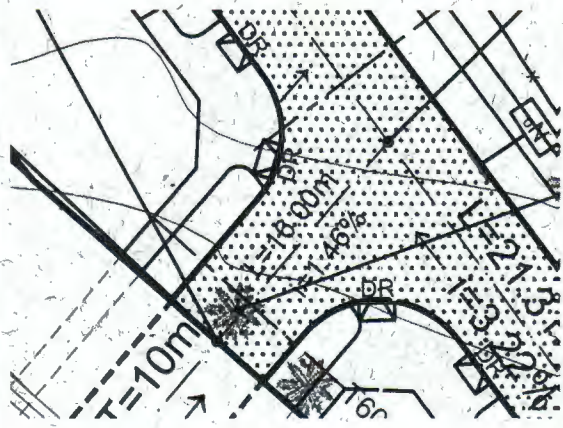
Acera proyectada en intersección calle Club de Leones con pasaje 2, según lámina 1 de 10 del plano "Planta de Pavimentación".
